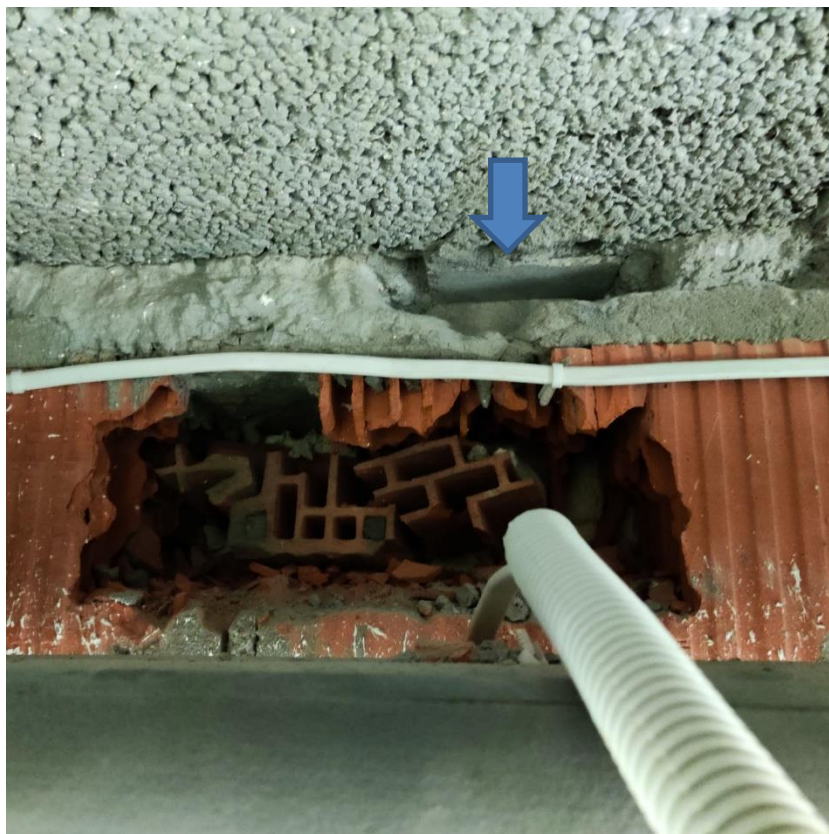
Widok zabetonowanego żebra rozdzielczego (po skuciu pustaków).
